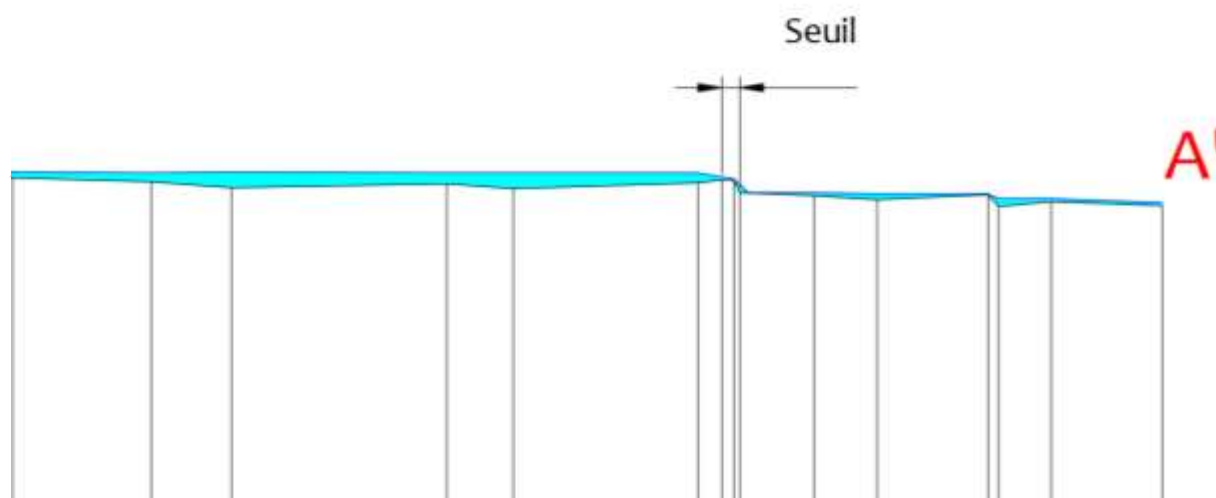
Extrait du profil en long du secteur – Zoom sur le seuil
